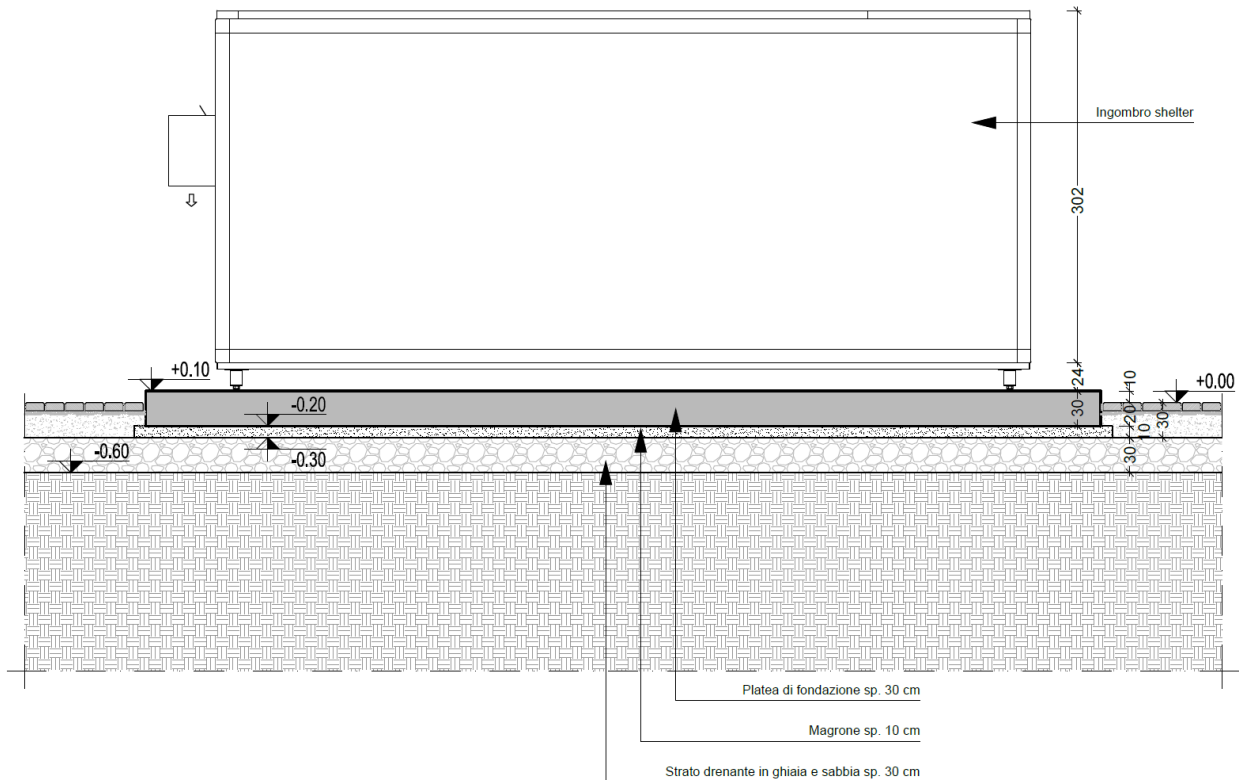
Sezione tipo basamento fondazione e Shelter per PPT
